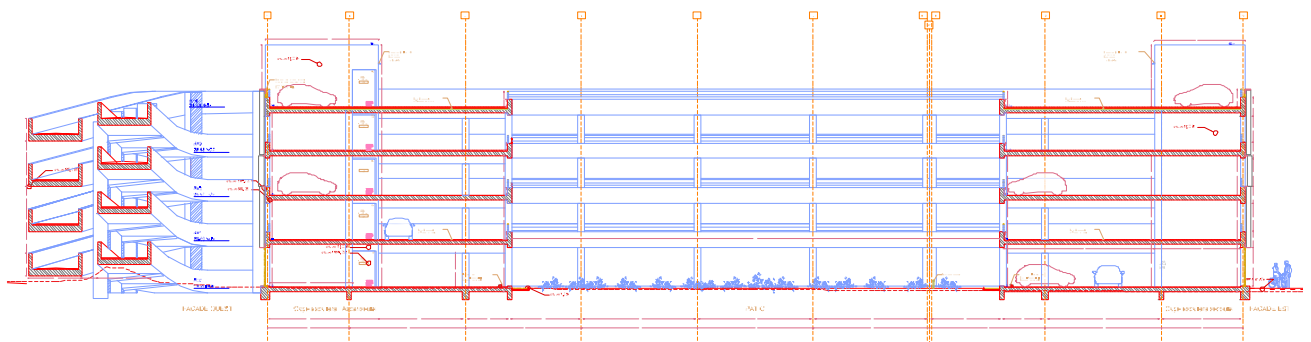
Vue en coupe du parking P+R de Villenave d'Ornon
